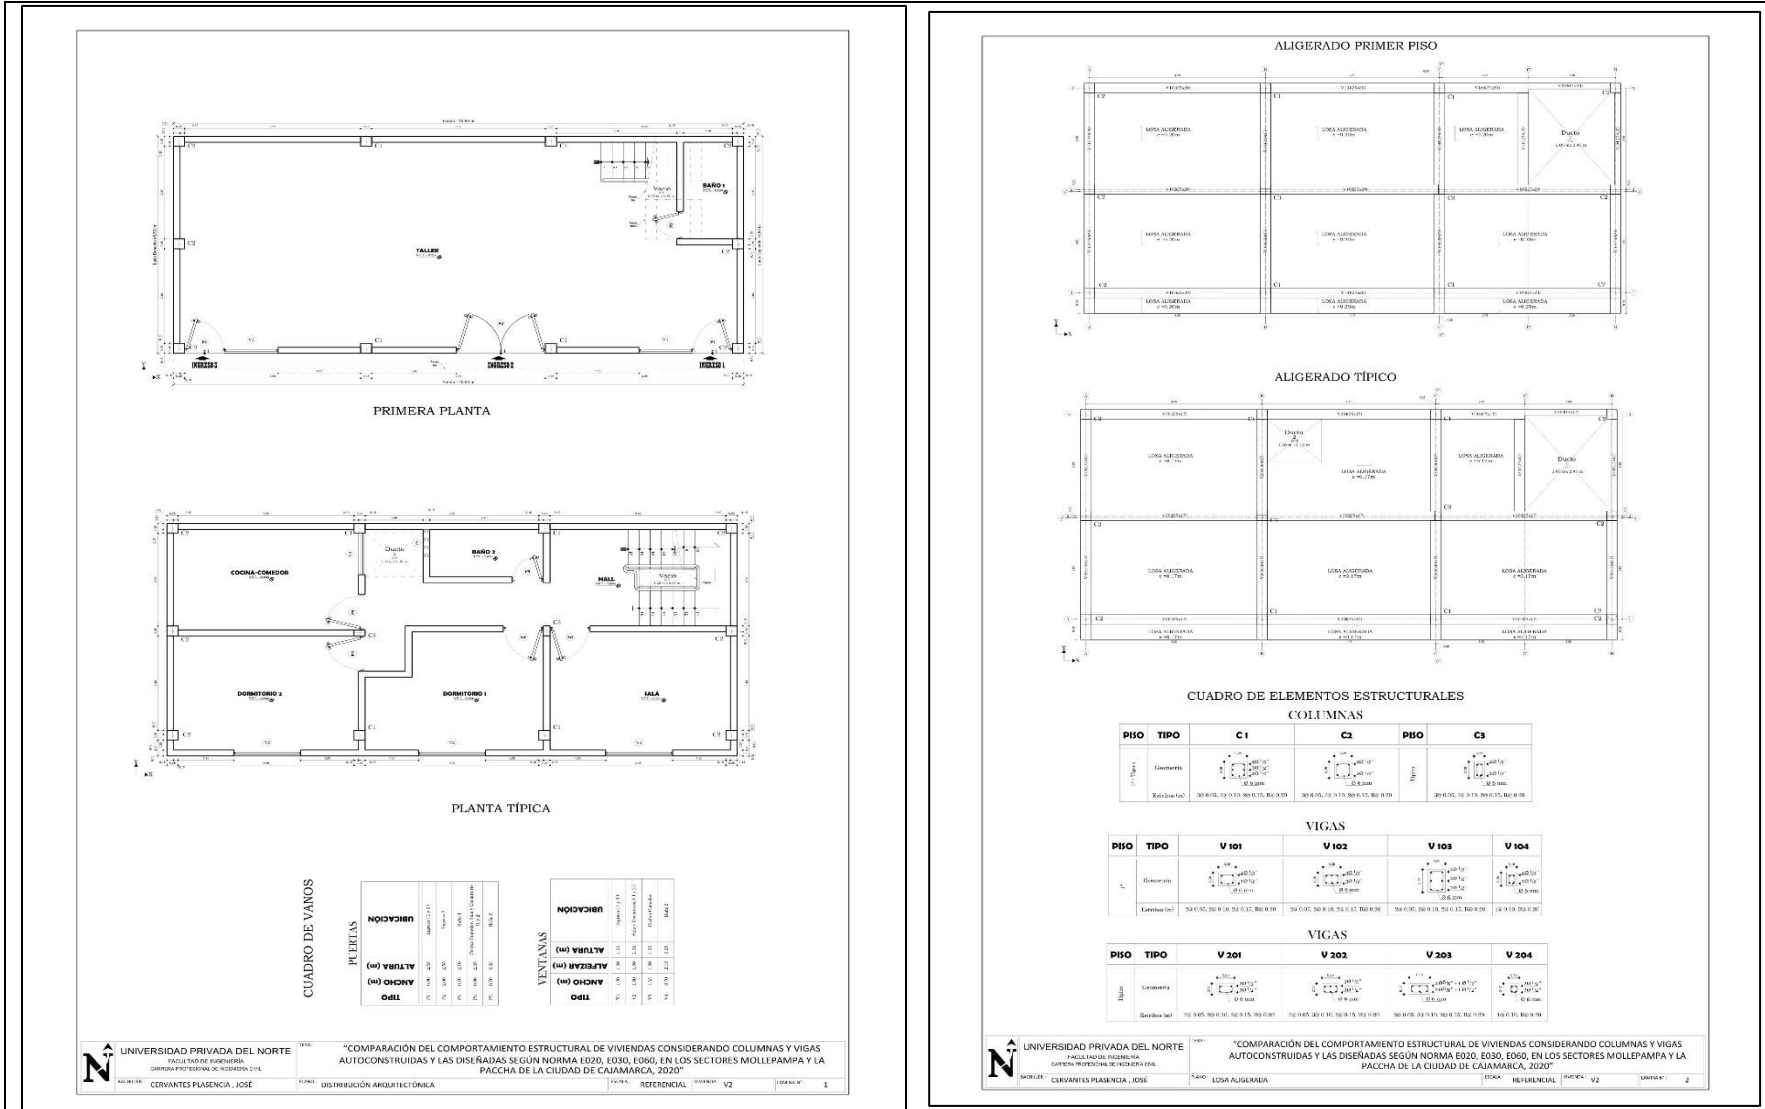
Planos de arquitectura y losa aligerada vivienda 2
